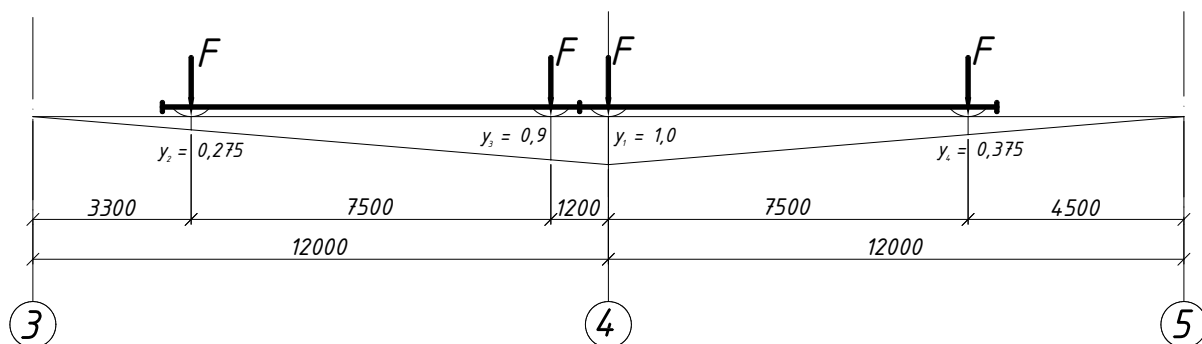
Загрузка колонны типовой (для расчетной рамы) оси двумя кранами
